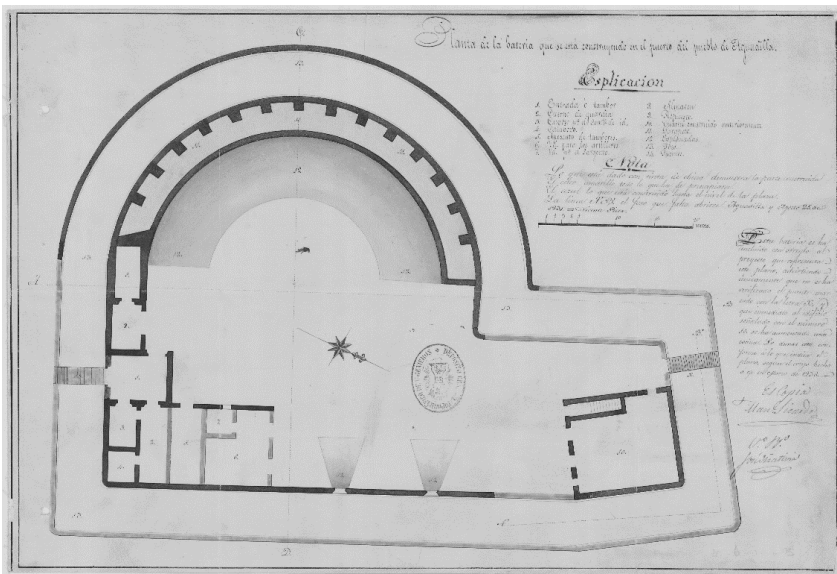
Planta de la batería que se está construyendo en el puerto del pueblo de Agudilla. AGMM, Cartoteca, sig. PRI-15/3.
